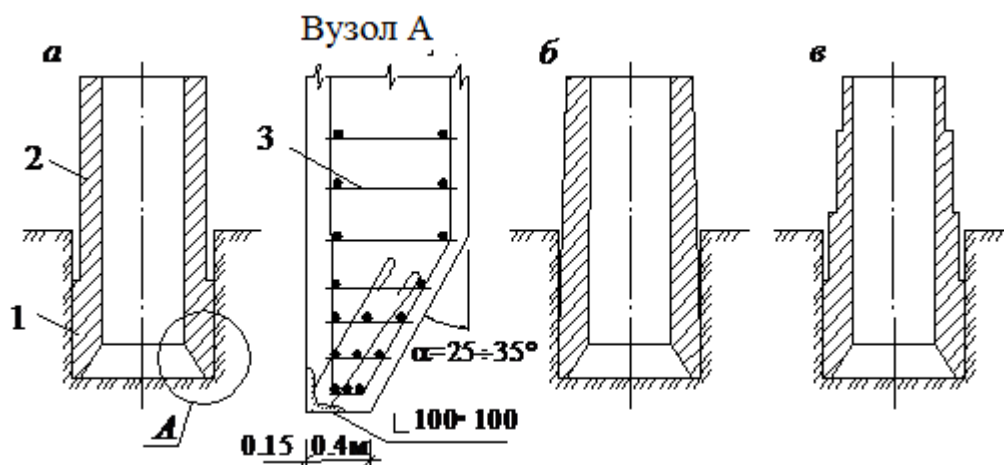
Форми вертикальних перерізів опускних колодязів:
